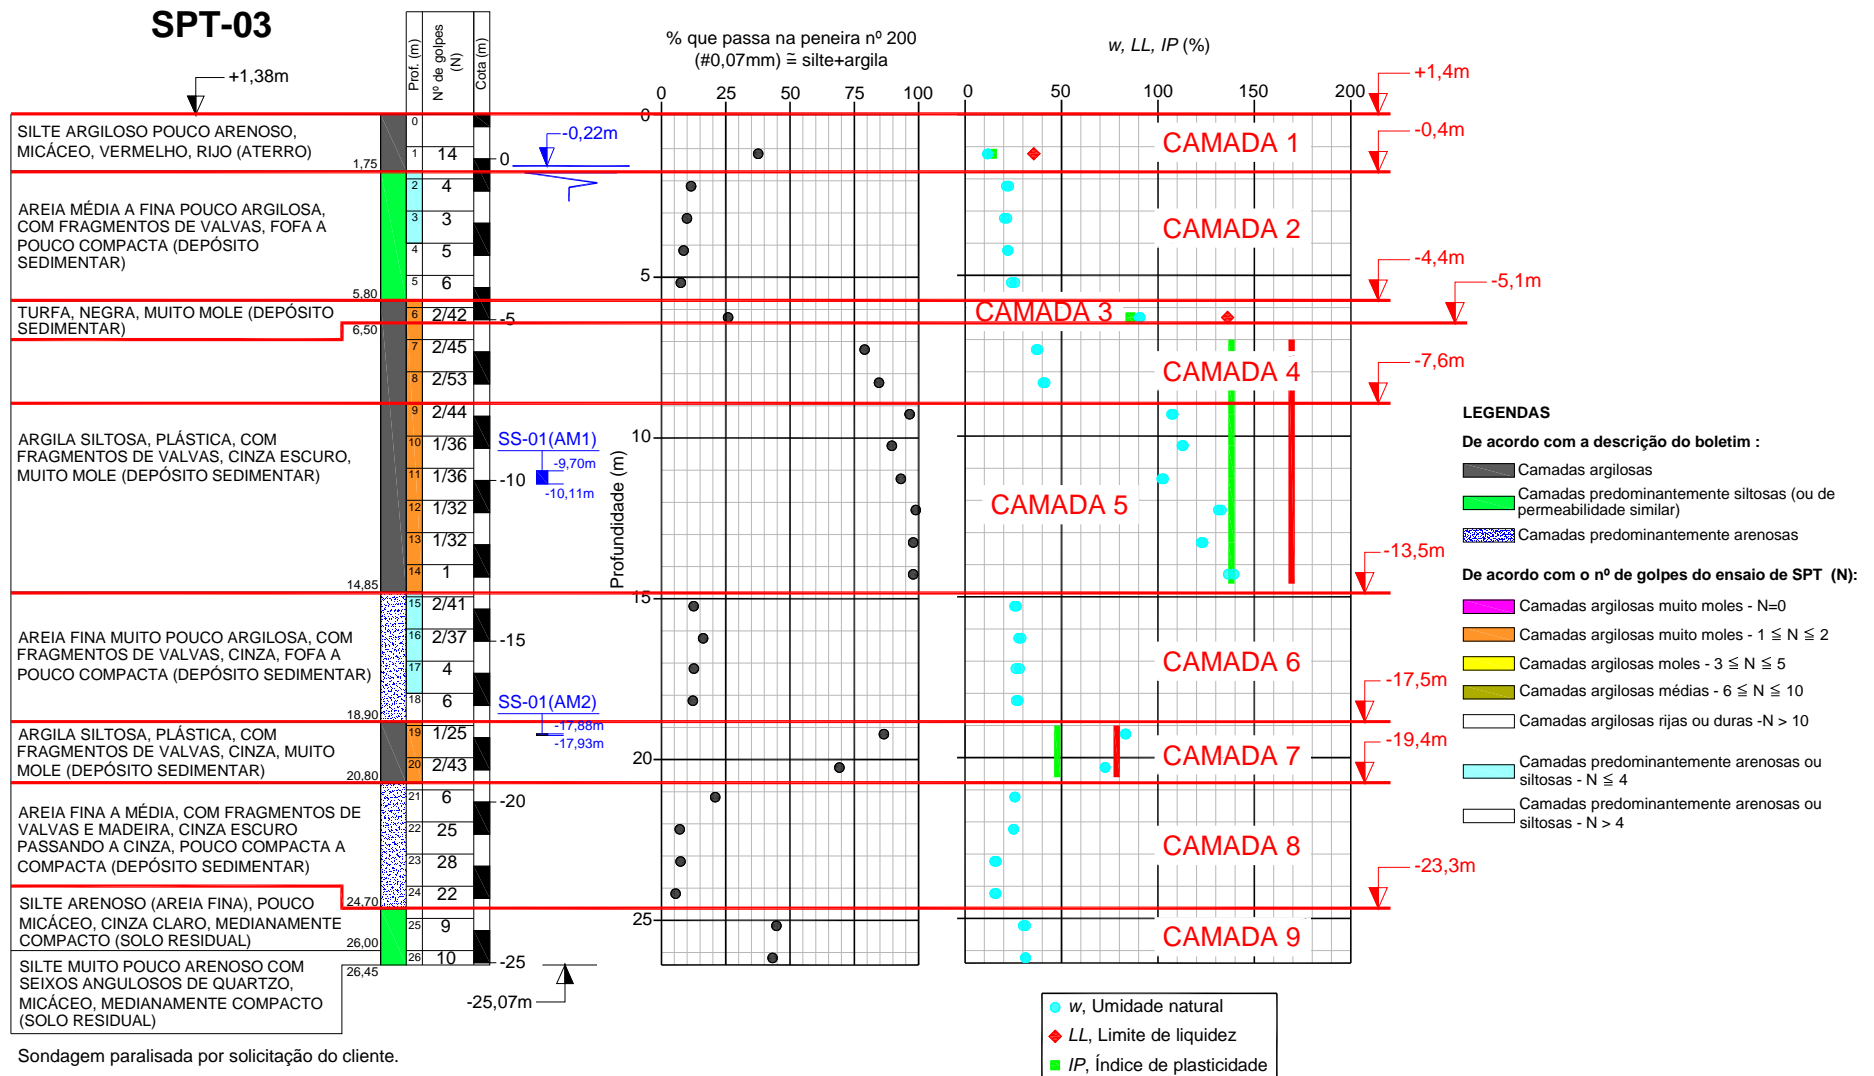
Perfil geotécnico no local da sondagem SPT-03 com a divisão em camadas adotada para o terreno
